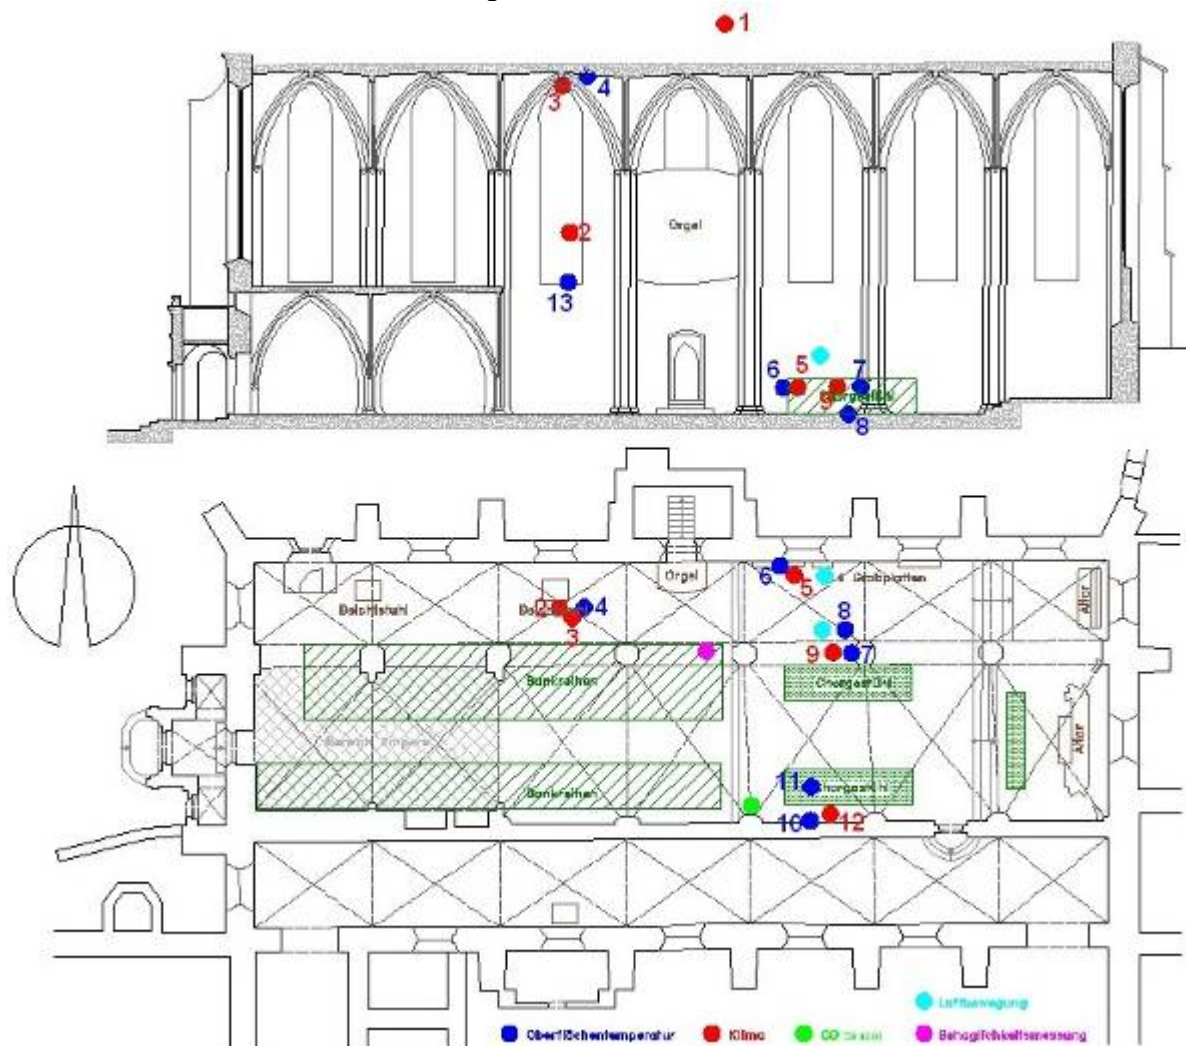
Grundriss und Schnitt der Klosterkirche St. Marienstern mit den Messpunkten der Raumklimamessung
